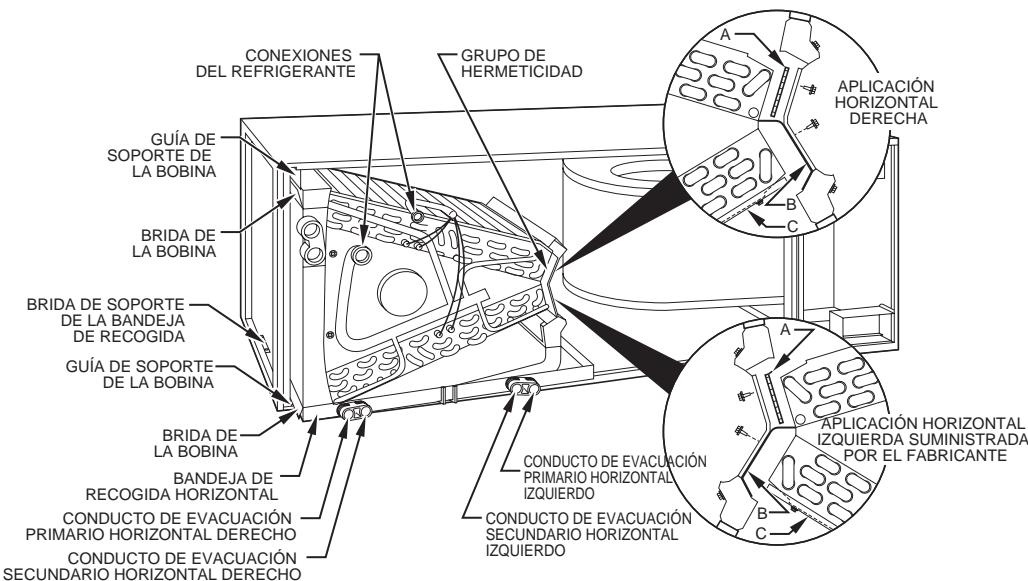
Unidad con bobina inclinada en aplicación horizontal izquierda
